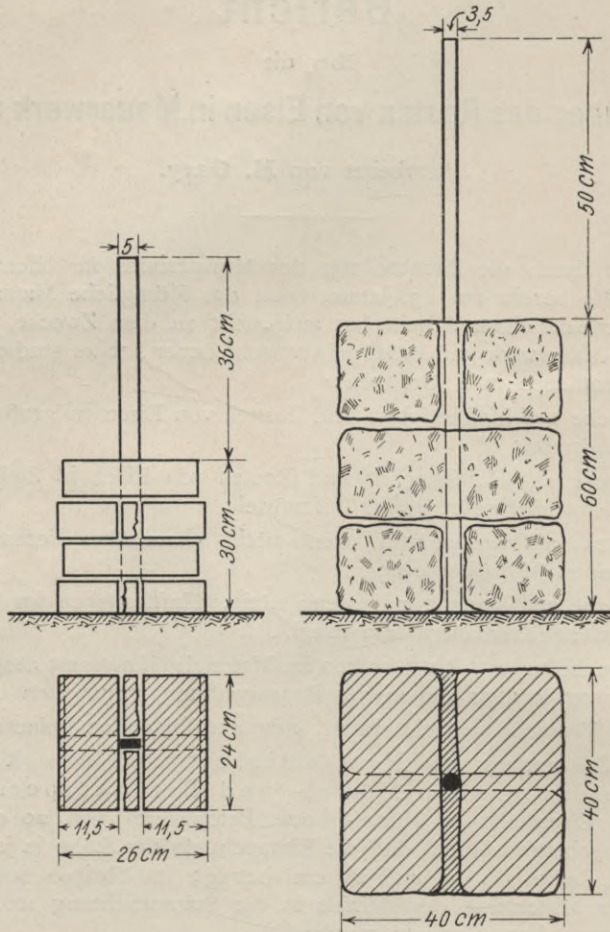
Ziegel- und Bruchsteinkörper mit Flacheisen und Rundeisen.
